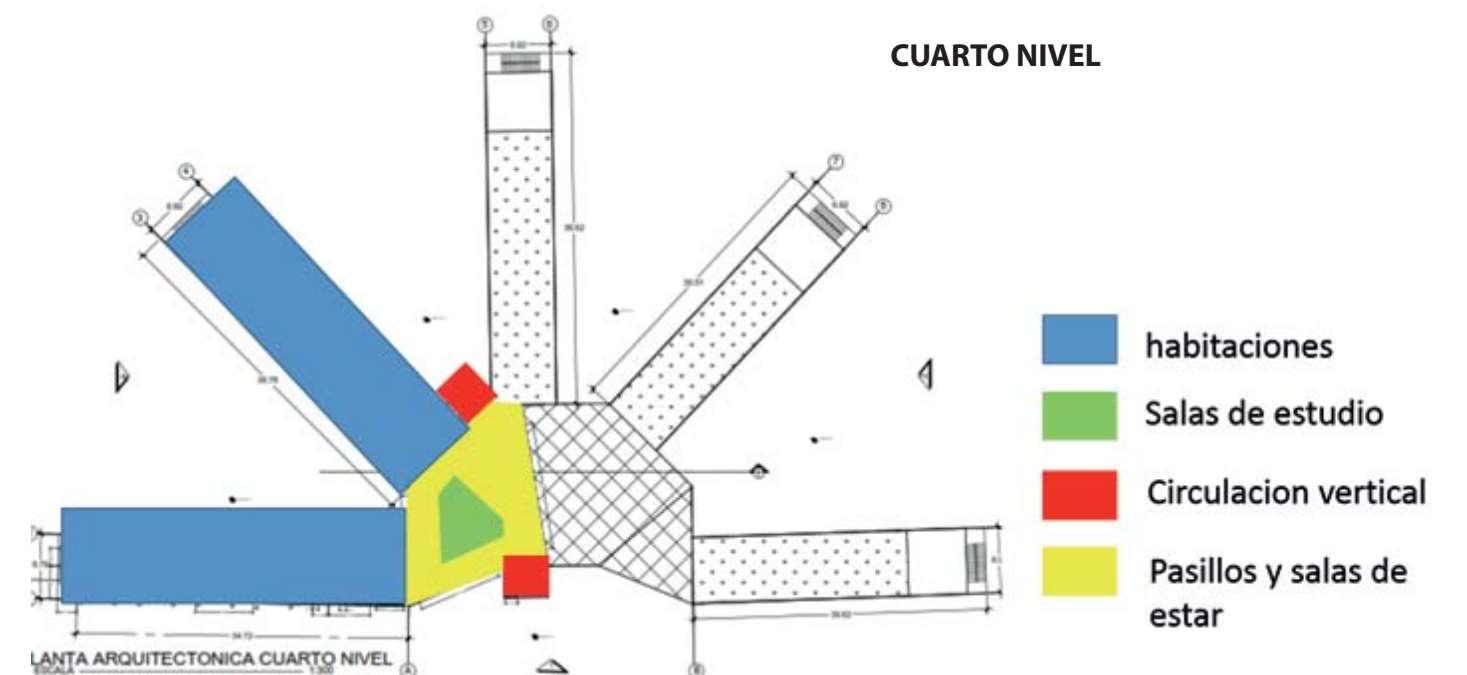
Distribución de la planta arquitectónica del cuarto nivel
